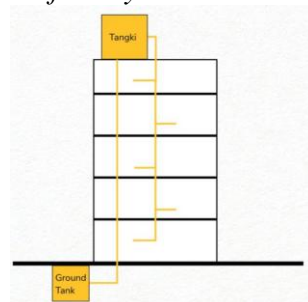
Konsep Struktur dan Utilitas Bangunan
